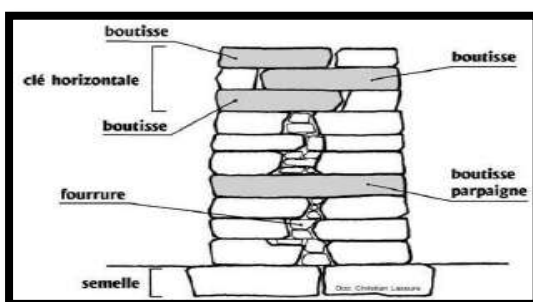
Mur de pierre en maçonnerie de moellon source auteur
